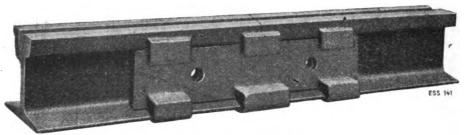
Schweißstoß mit Flachlaschen.
